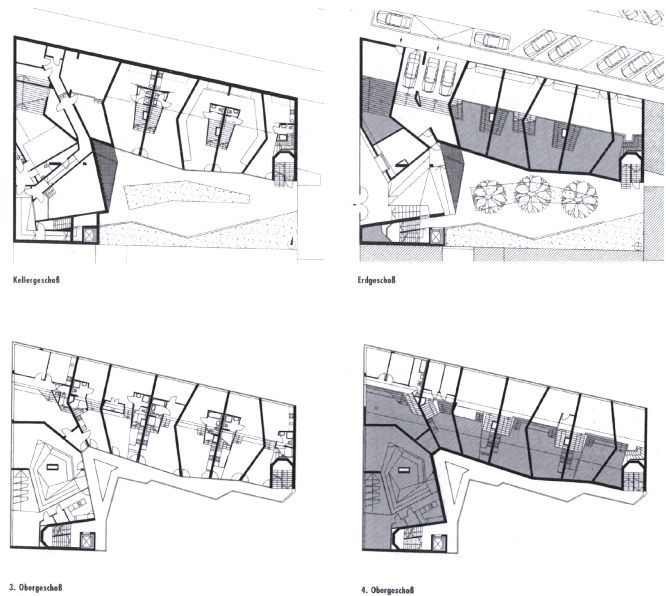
Grundriss “Miss Sargfabrik”
